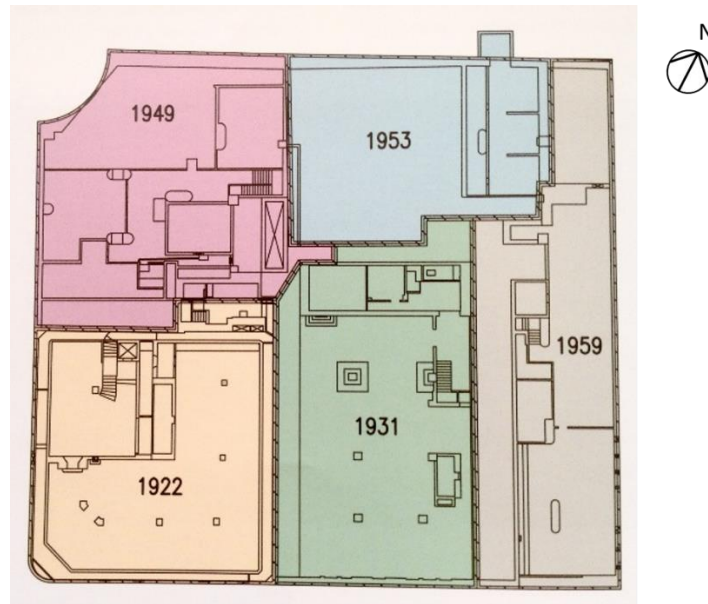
Planta térreo ed. Galeria: etapas de construção. Fonte: Pinheiro (2011)
